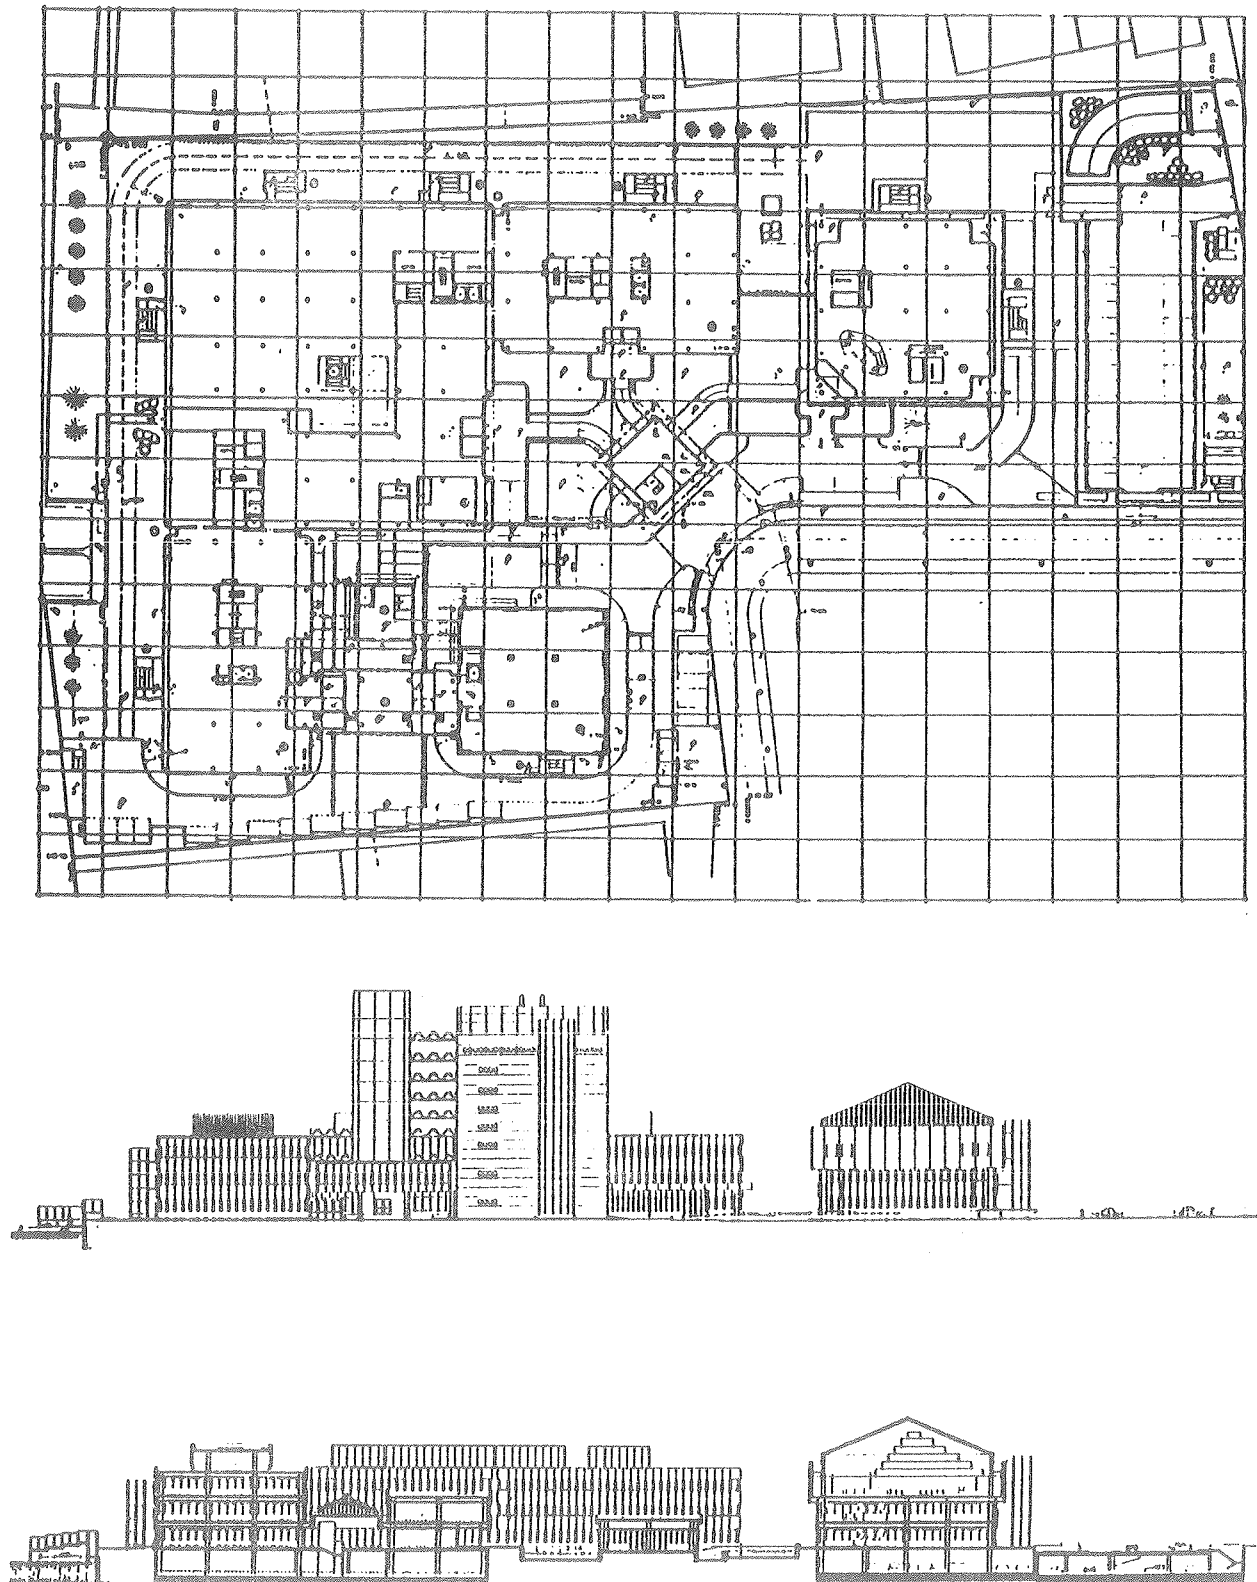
Centro Servizi di Mestre della Cassa di Risparmio di Venezia : pianta - prospetto - sezione
